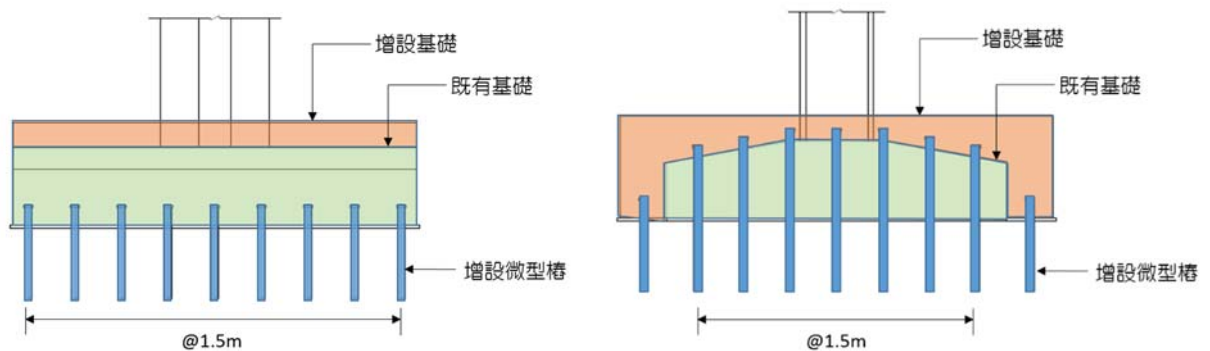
彰化一號高架橋 基礎增設微型樁補強 補強示意圖
